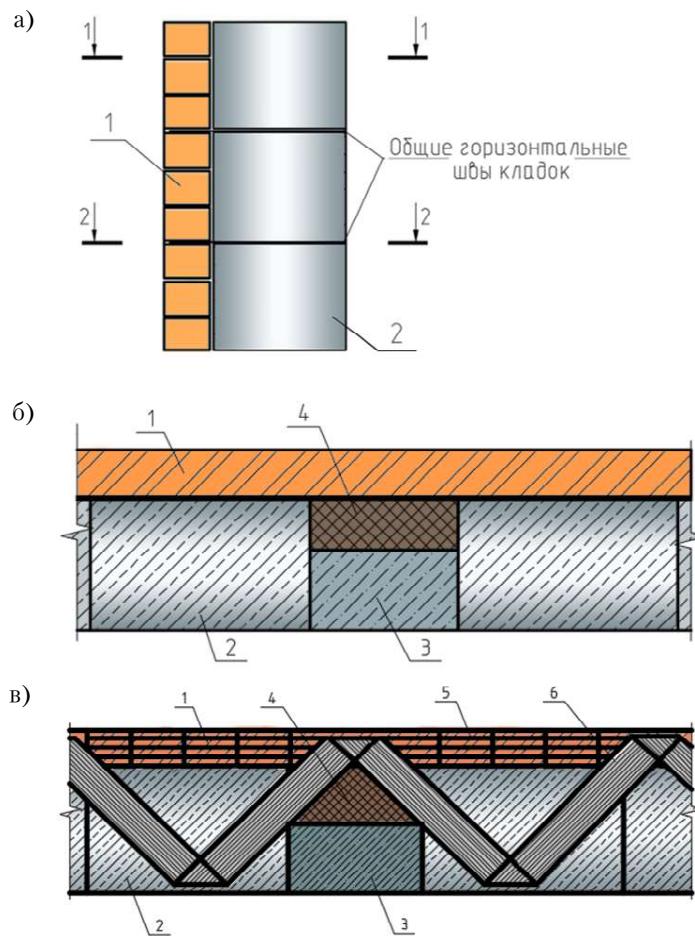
Конструкция самонесущей энергосберегающей стены с вариотропными свойствами: а) вертикальное сечение стены; б) разрез 1-1; в) разрез 2-2; 1 – наружный облицовочный слой из кирпичной кладки; 2 – внутренний слой из ячеистобетонных блоков с вариотропной паропроницаемостью; 3 – железобетонный элемент каркаса здания; 4 – эффективный утеплитель, например плиты из минеральной ваты; 5 – сетка из базальто-пластиковой арматуры; 6 – тканый холст на основе односторонних высокопрочных углеродных волокон.
